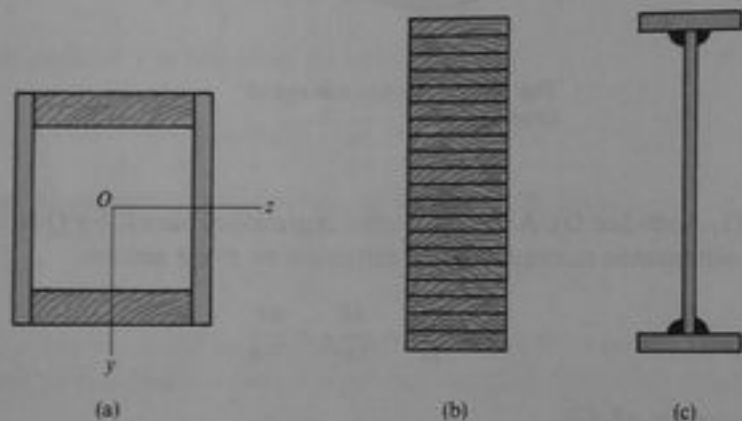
Vigas armadas: (a) viga tipo cajón de madera; (b) viga laminada pegada; y (c) viga armada soldada
